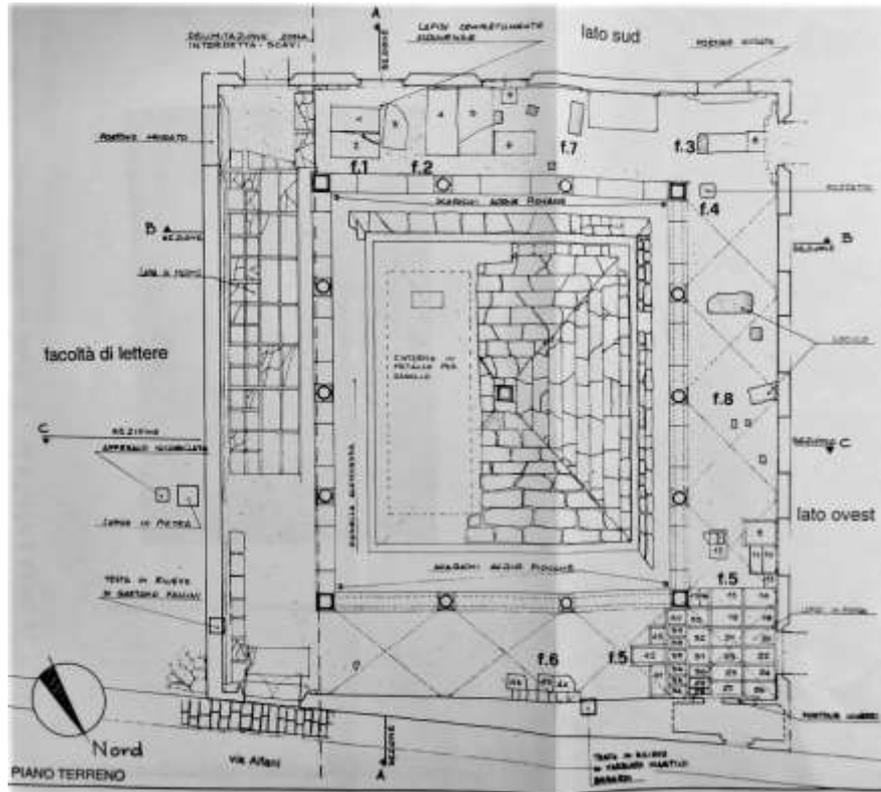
Intervento di restauro sulla pavimentazione del chiostro di levante, pianta piano terra, 1996, disegno a china su carta, 420x300 mm (UNIFI - Ufficio Tecnico).
